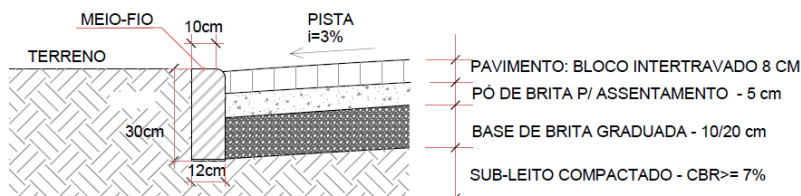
Corte Transversal – Pavimentação com bloco intertravado 8 cm
